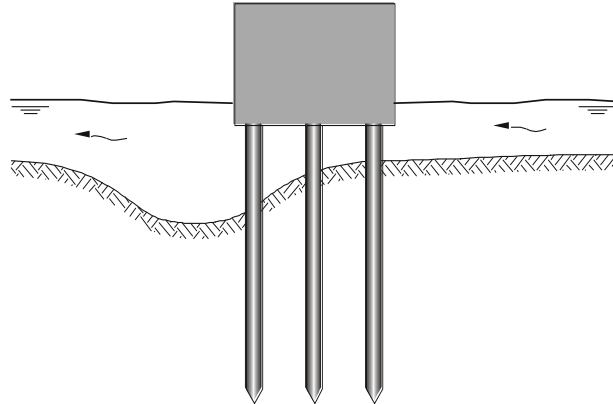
, APLICACIÓN DE PILOTES EN SITIOS CON POSIBLE EROSIÓN
